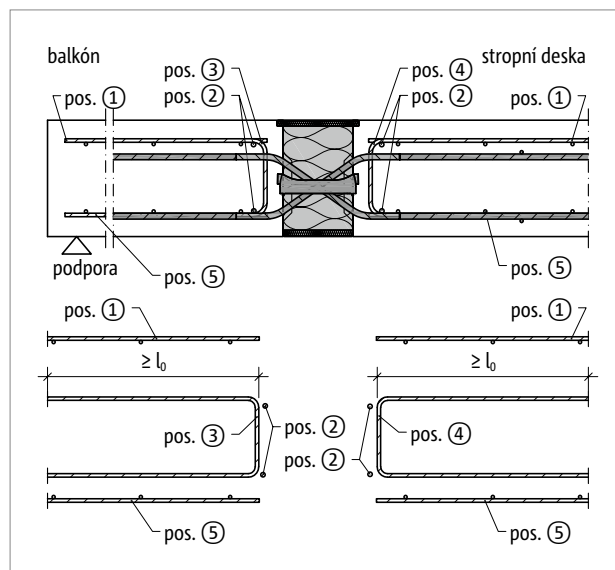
Schöck Isokorb® XT typ QL-V1 až V4: Napojovací stavební výztuž
